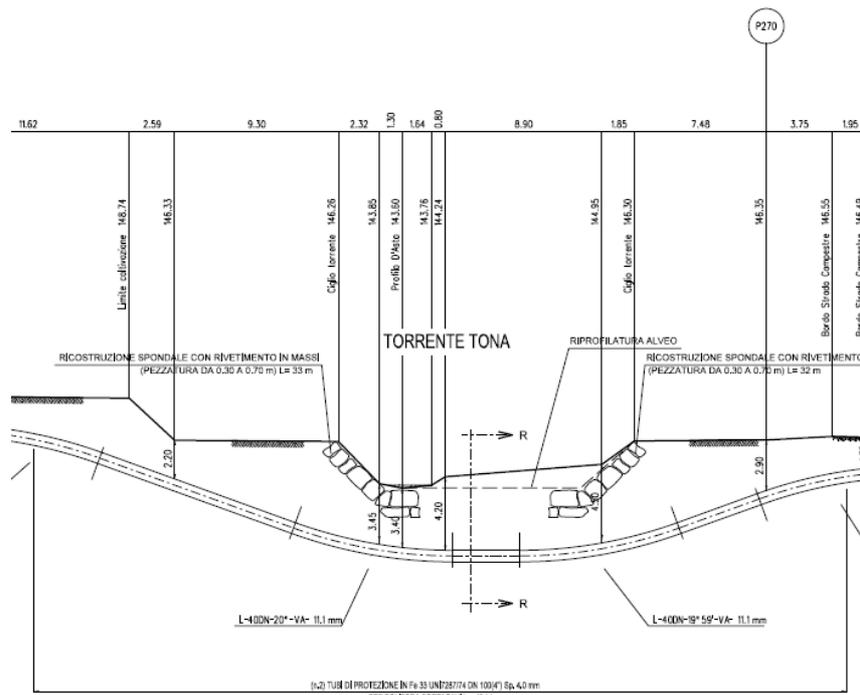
Attraversamento torrente Tona - Sezione schematica di progetto
